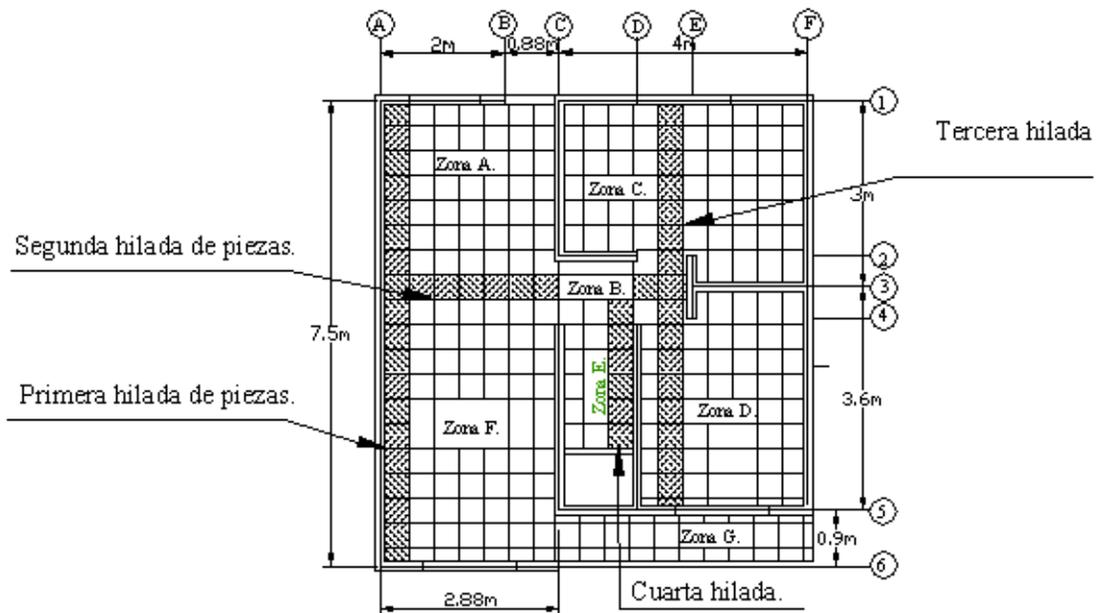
Planta arquitectonica Zonas de colocación e hiladas de piezas para guía.
